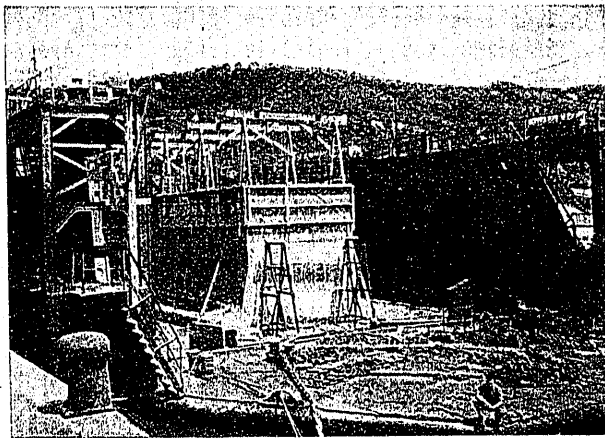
Otra fase más avanzada del hormigonado de los mismos.
